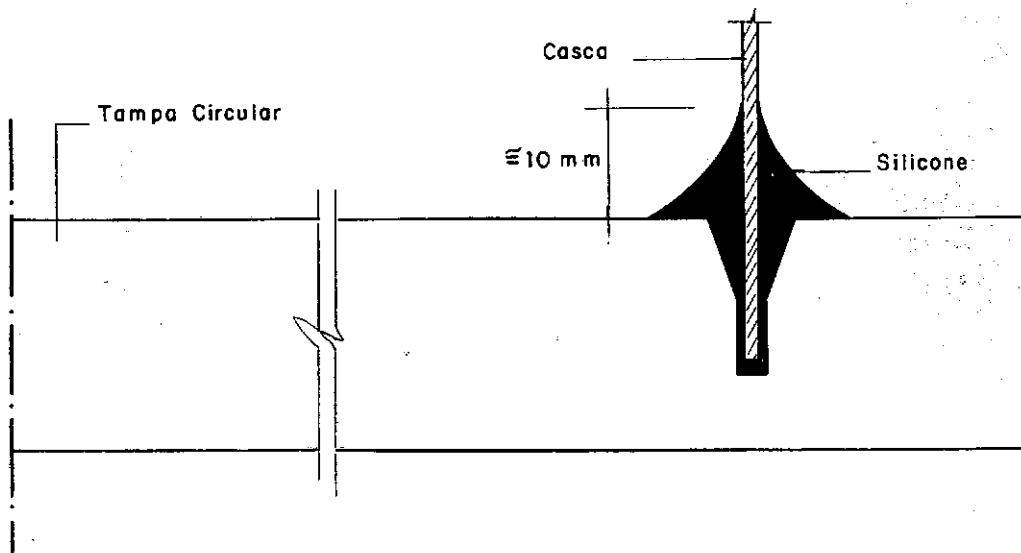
Detalhe da ligação tampa-casca para a condição de extremos simplesmente apoiados
